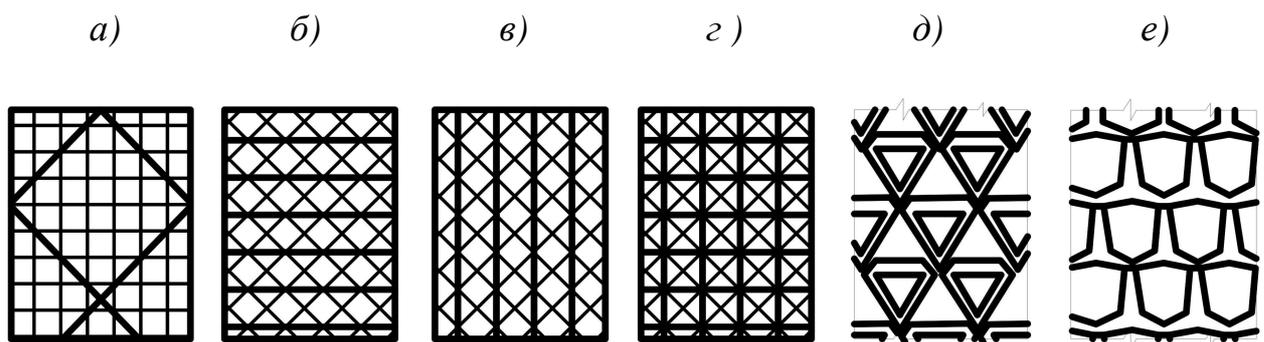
Схемы и примеры конструкций оболочки: *а* – с прямоугольными элементами жесткости; *б* – раскосной с ригелями; *в* – то же без ригелей; *г* – то же, с ригелями и стойками; *д, е* – примеры сборно-монолитных оболочек
